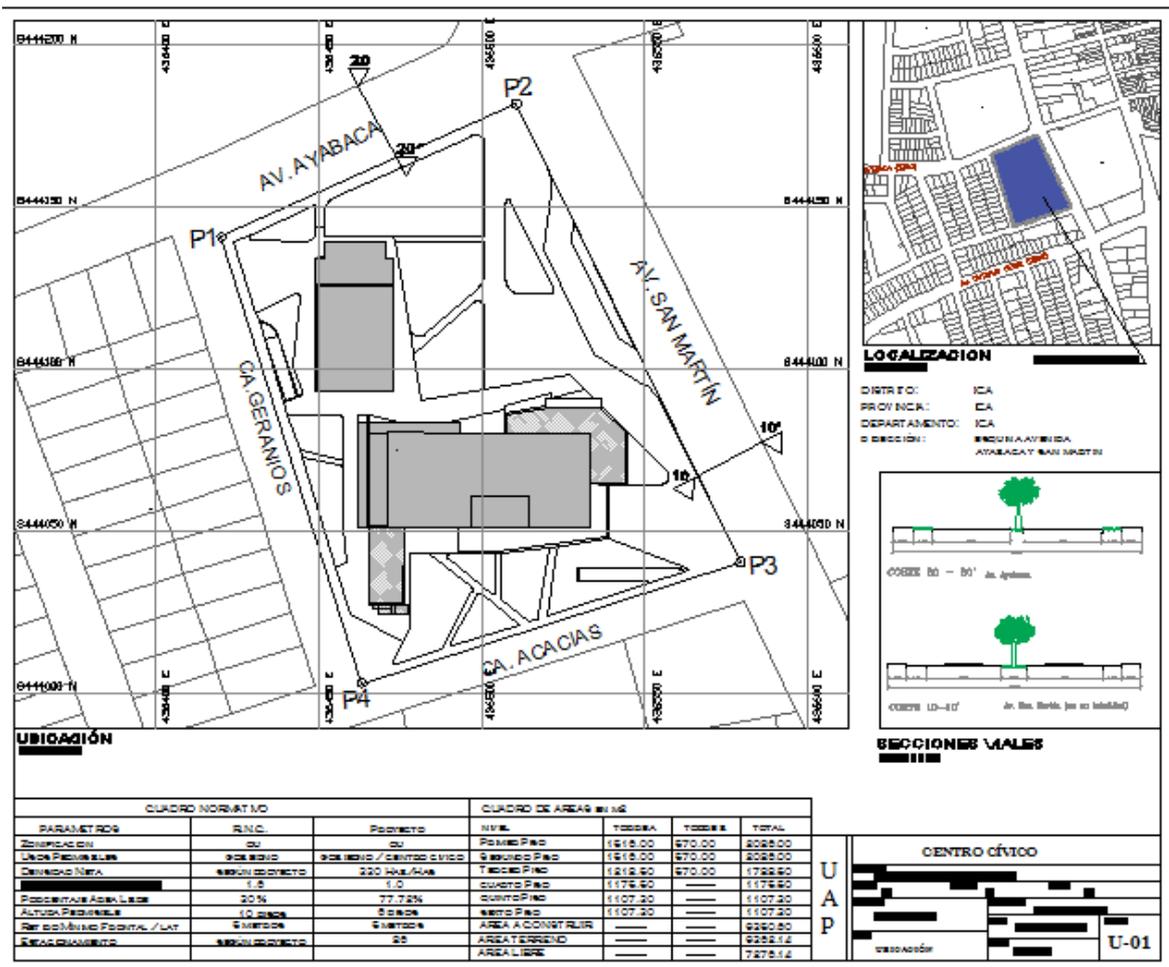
Plano de Ubicación Proyecto Centro Cívico.
